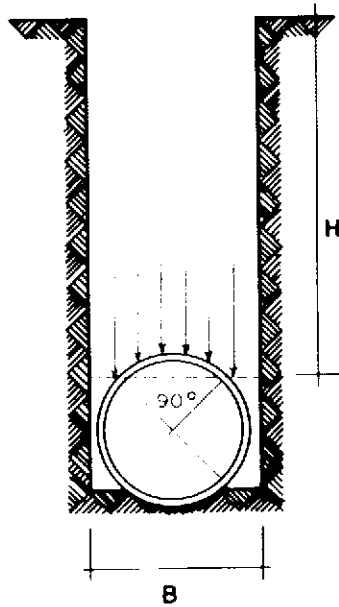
Cargas sobre conductos de sección circular, enterrado en zanja.
